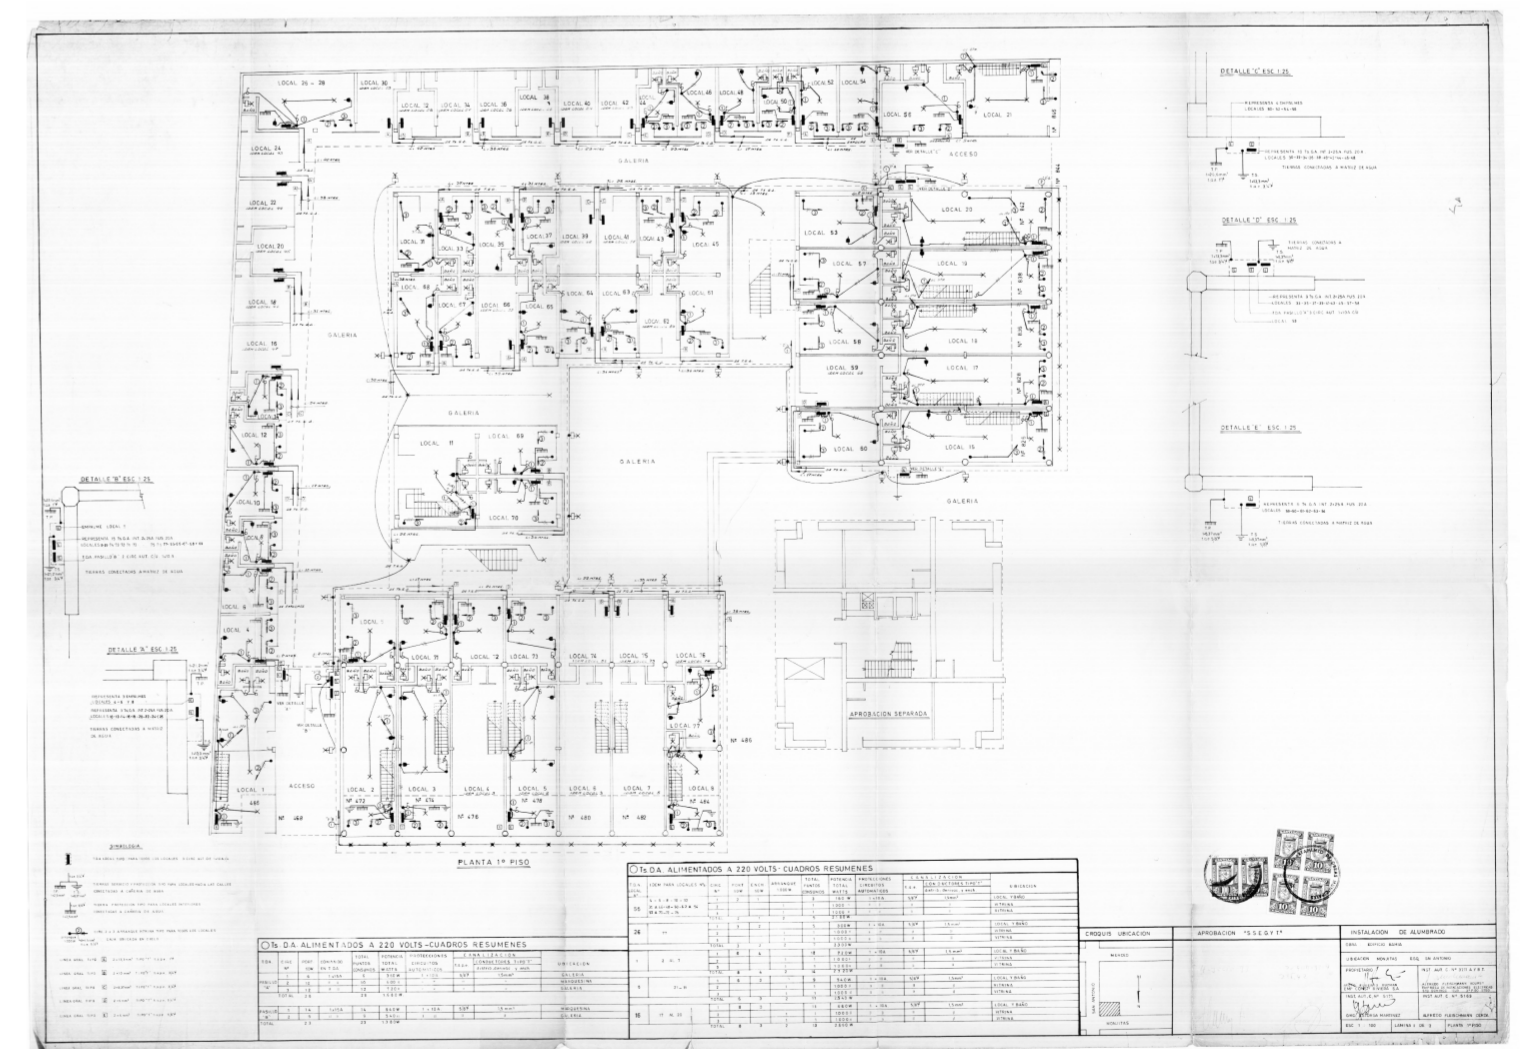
Archivo Plano Municipal. Planta instalación alumbrado.
